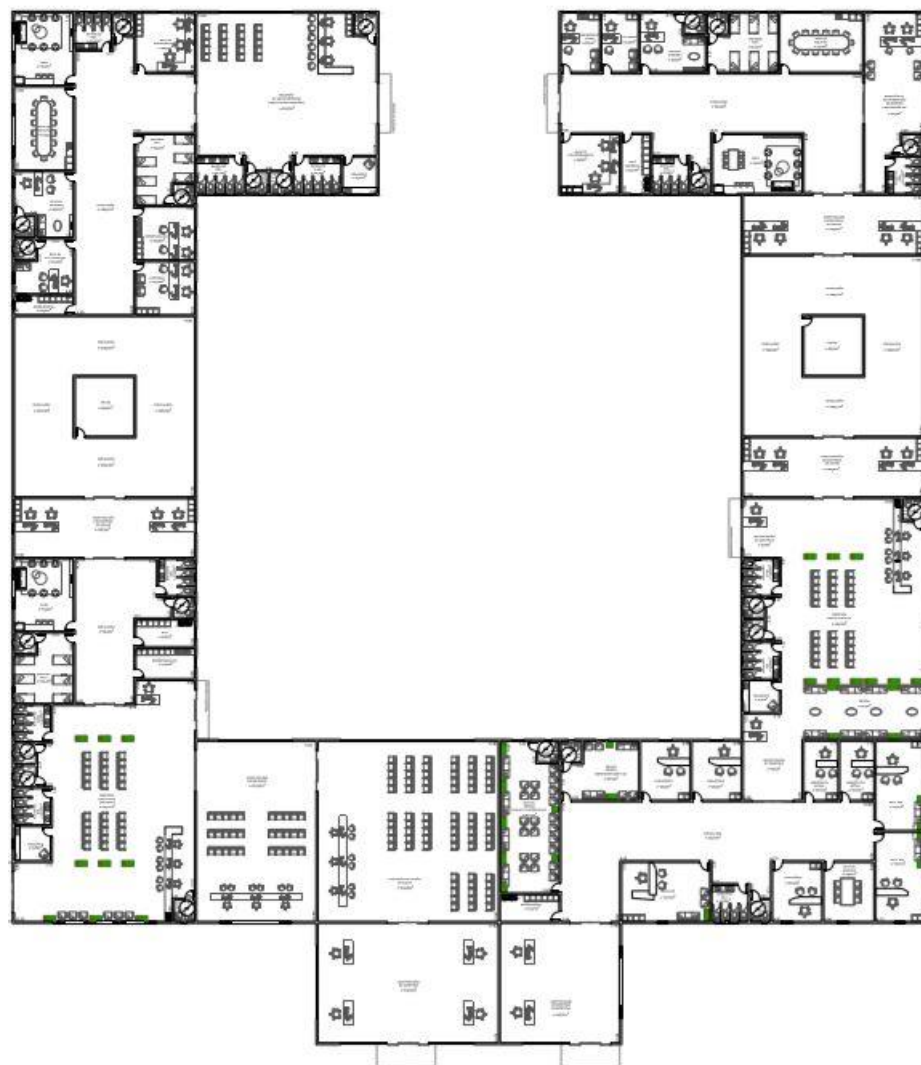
Planta Humanizada – Fonte: Acervo Próprio
